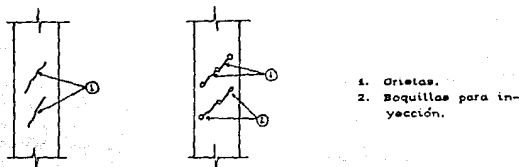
Inyección de resina en grietas en columnas.
